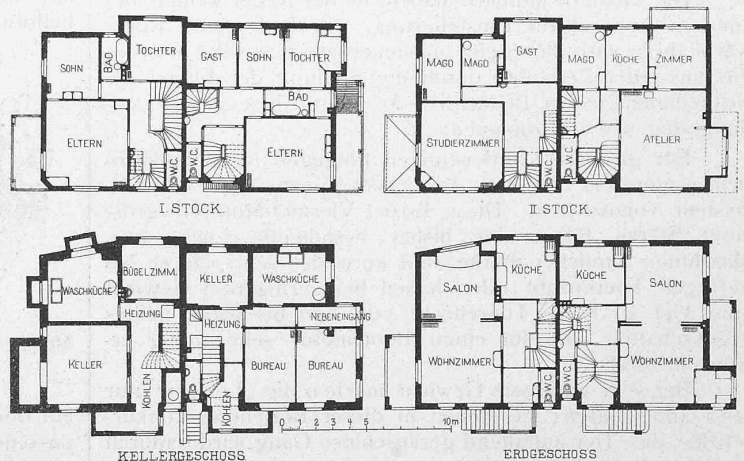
Doppelvilla an der Klosbachstrasse (Nr. 134, 136). — Grundrisse. — 1 : 400.
